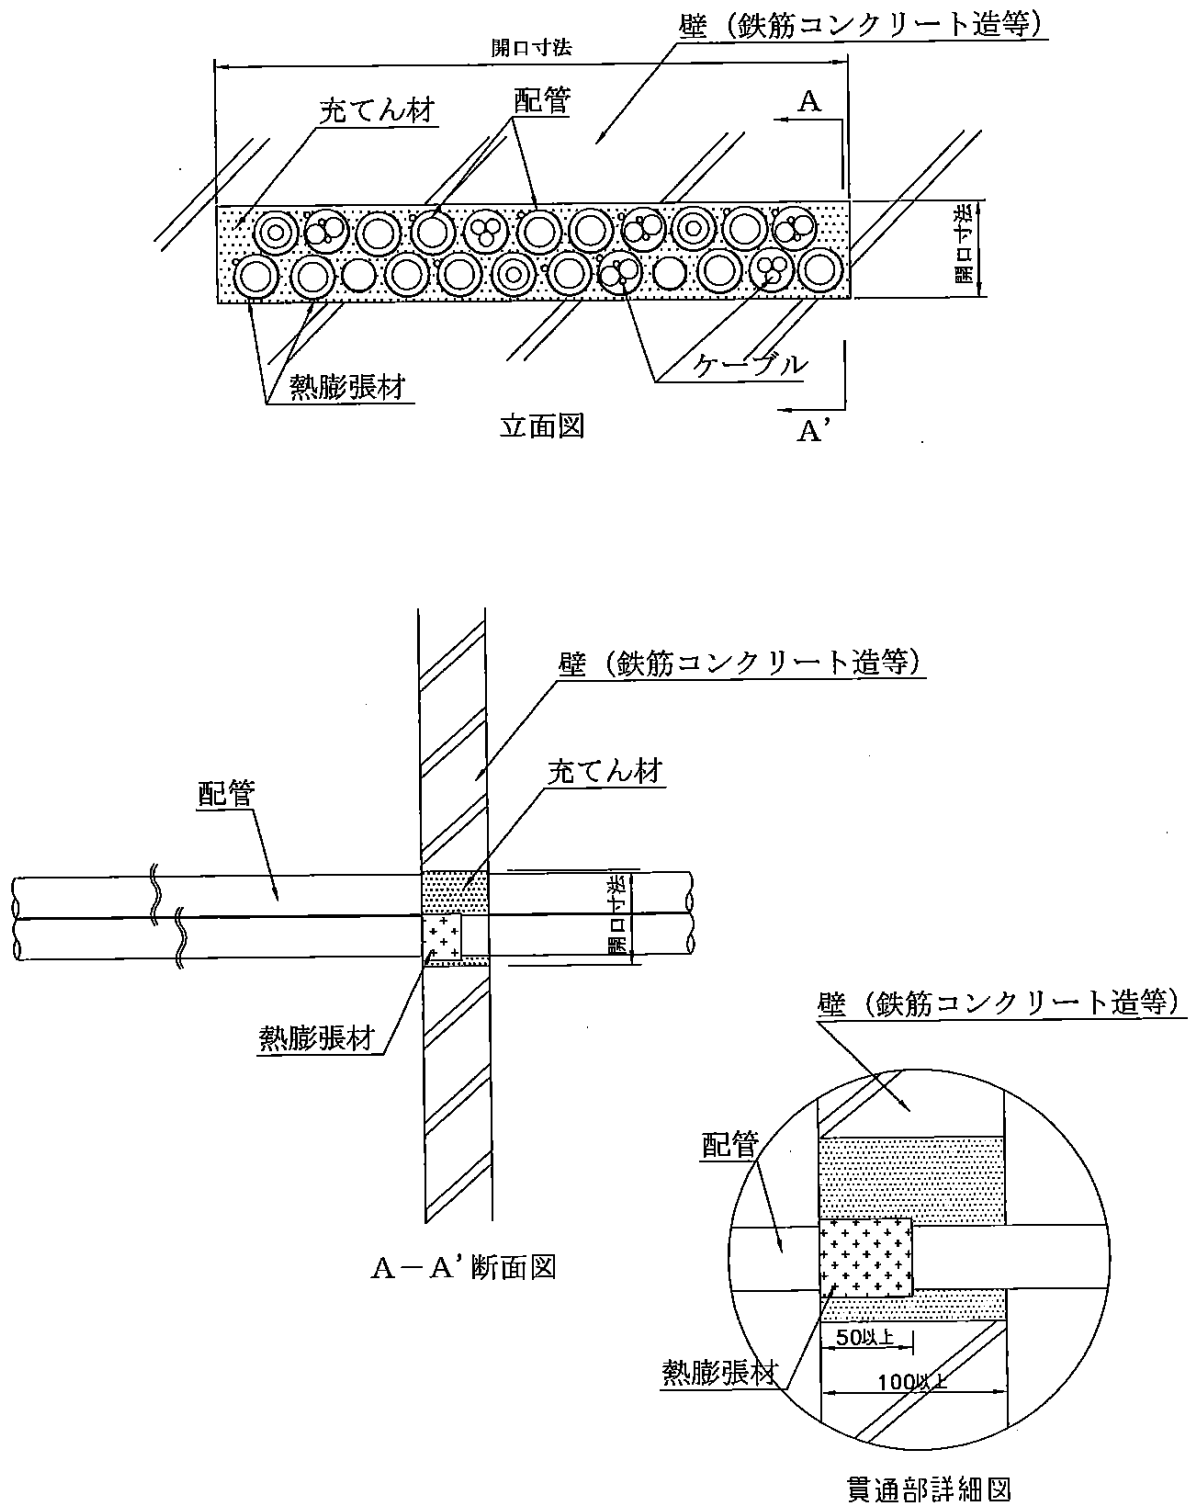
施工図 (矩形の開口部、鉄筋コンクリート造等の場合)
